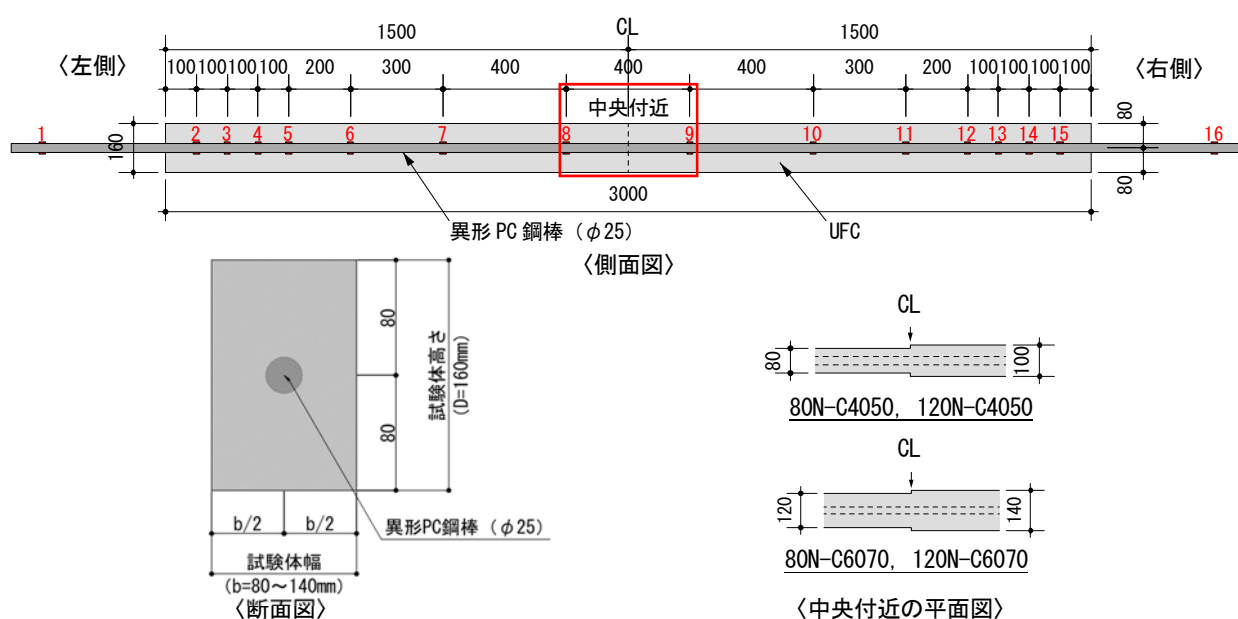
試験体形状・寸法と異形 PC 鋼棒のひずみ測定位置
